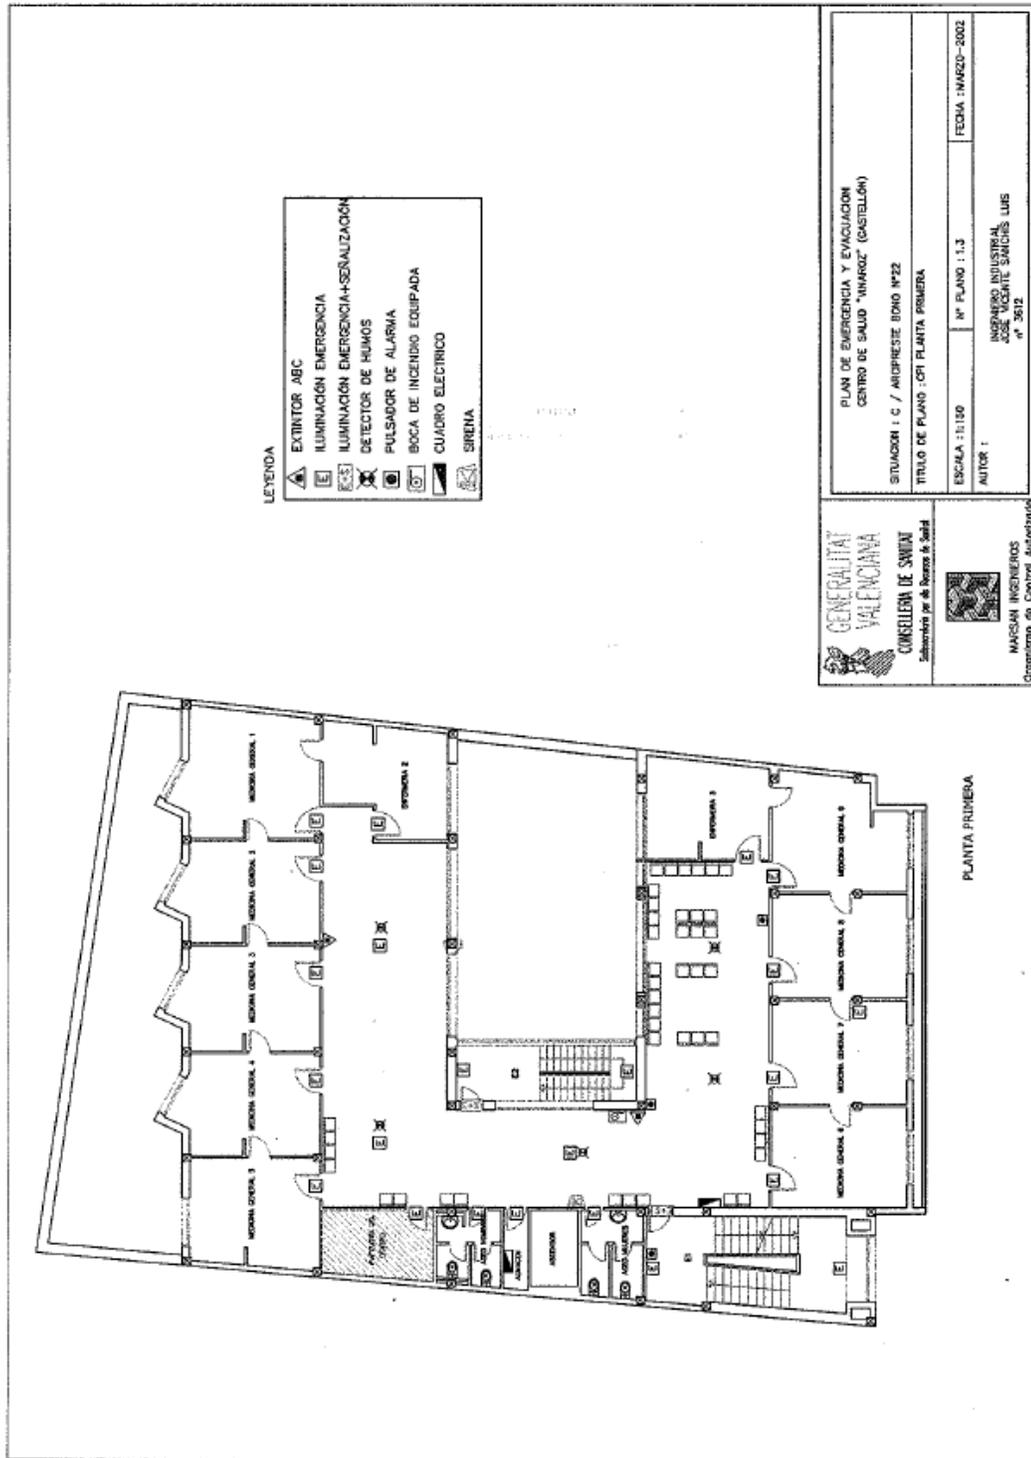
Esquema planta primera del centro de salud de Vinaroz.
